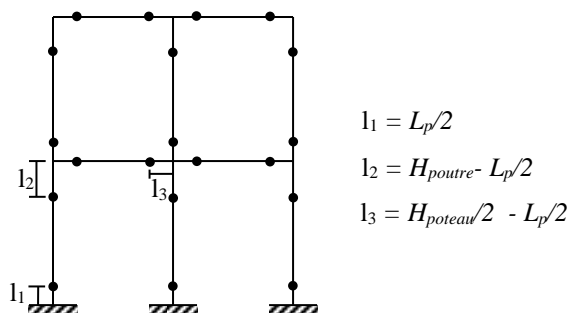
Localisation des rotules au niveau des poteaux et des poutres.
